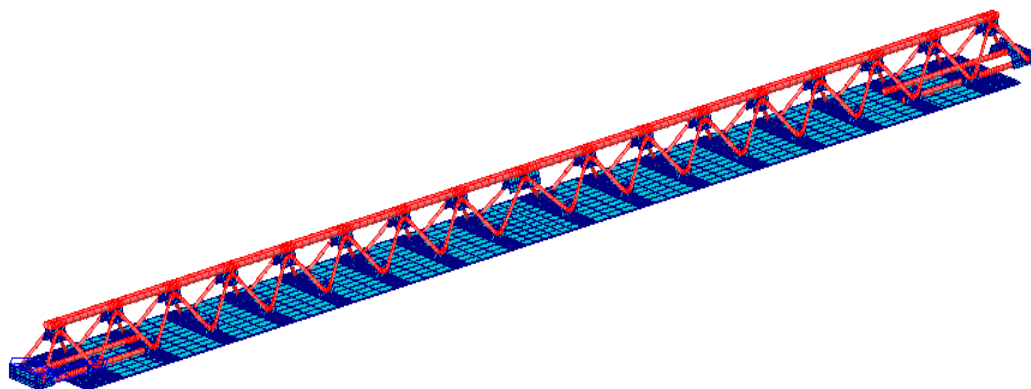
TRR PONTE: piatto al corrente inferiore, fazzoletti rettangolari, passo piramidale
